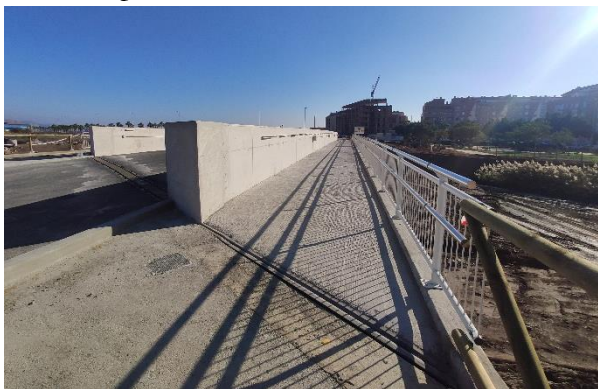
Detalle del voladizo de la margen derecha, donde se aprecia el fuerte esviaje
